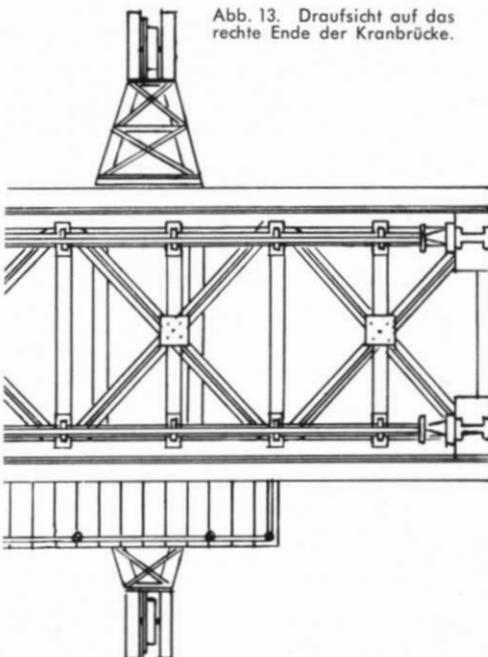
Draufsicht auf das rechte Ende der Kranbrücke.
